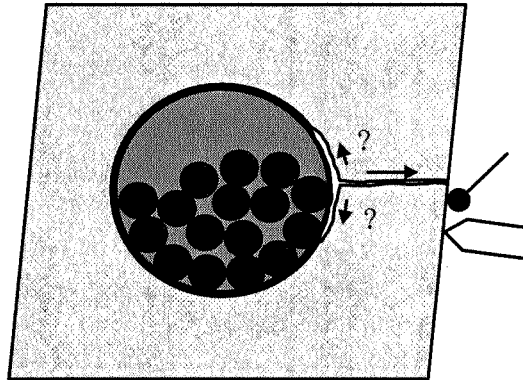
Fissuration longitudinale le long du câble
